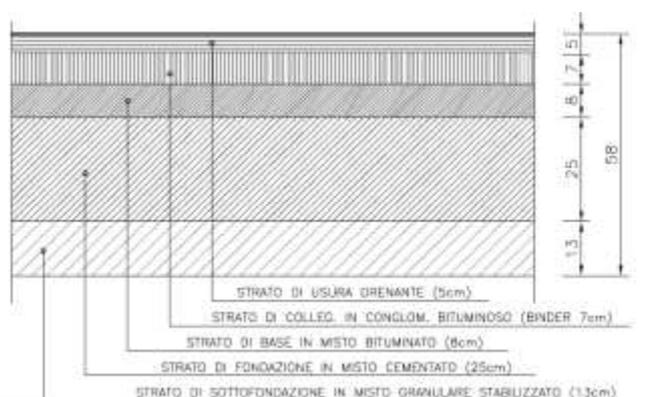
Pacchetto di pavimentazione tratti all'aperto
